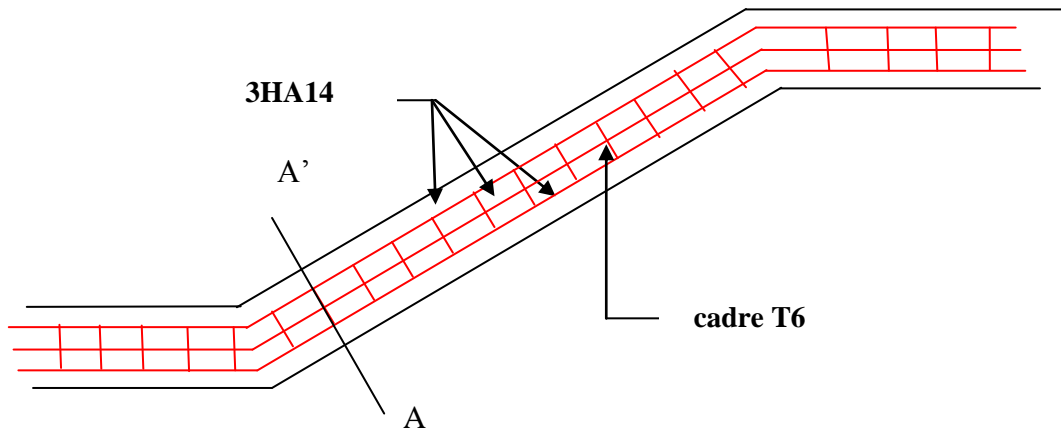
Schémas de ferrailage de la poutre brisée.
